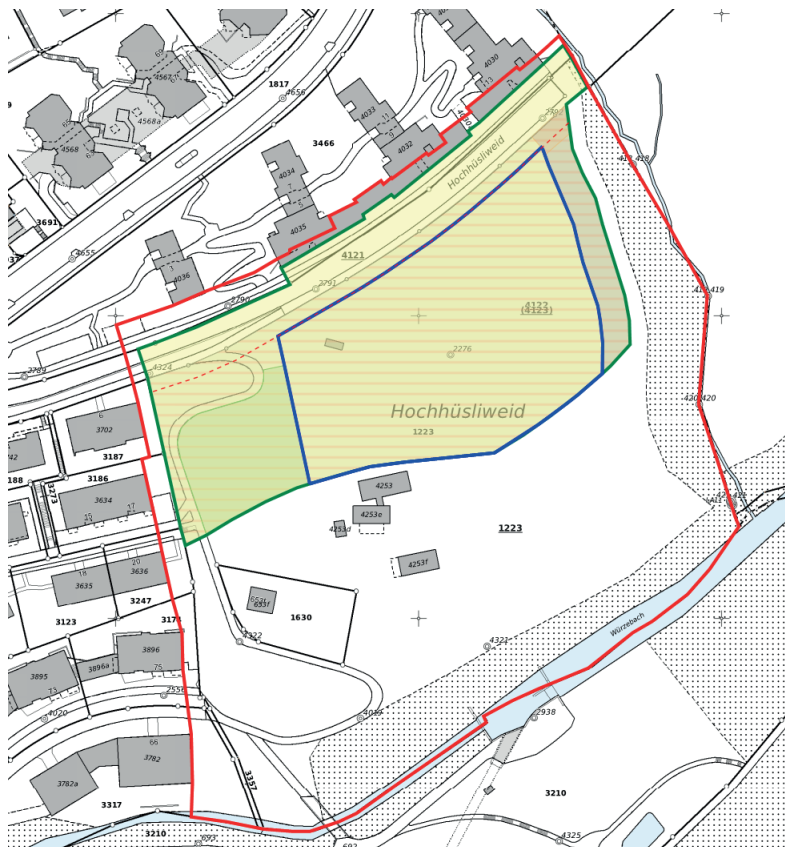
Betrachtungs- / Freiraum- und Bauperimeter sowie Perimeter Gestaltungsplan
